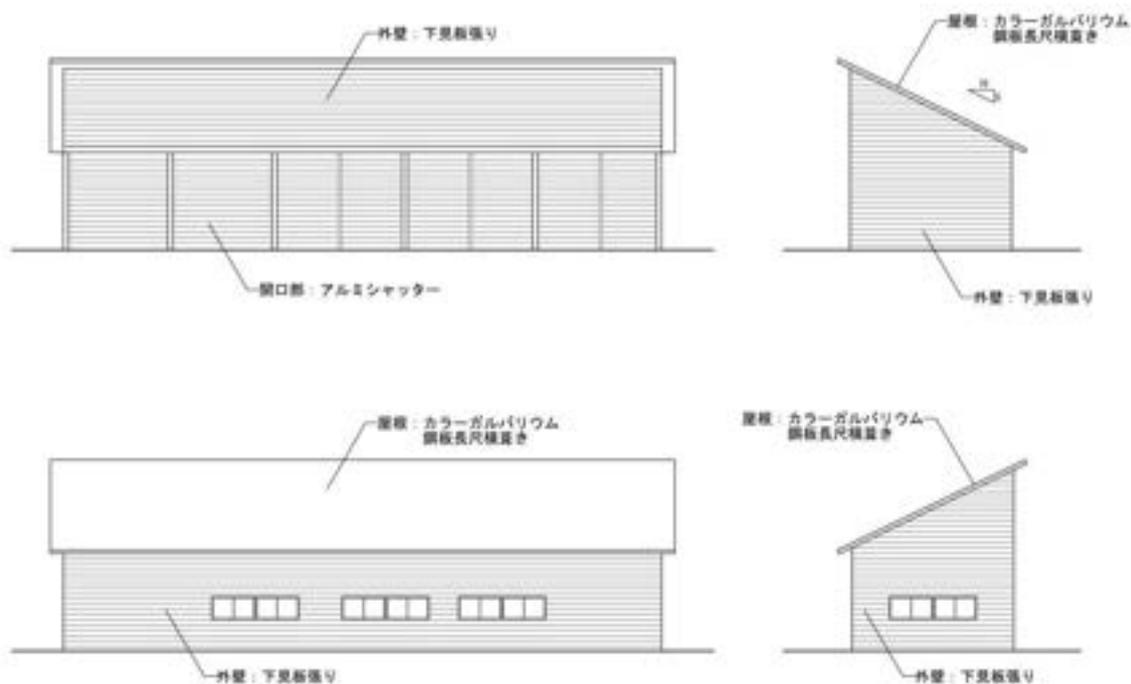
むら湯・湯ら里薪ボイラー棟 計画立面図
